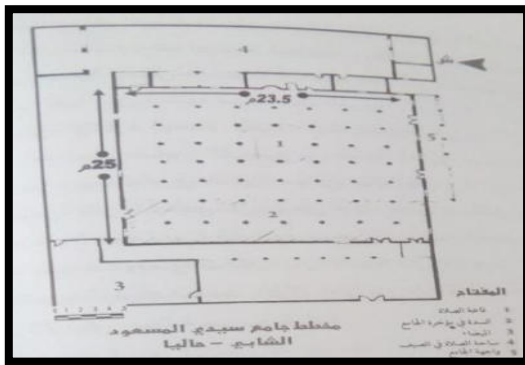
Plan d'une mosquée de Sidi Messaoud
